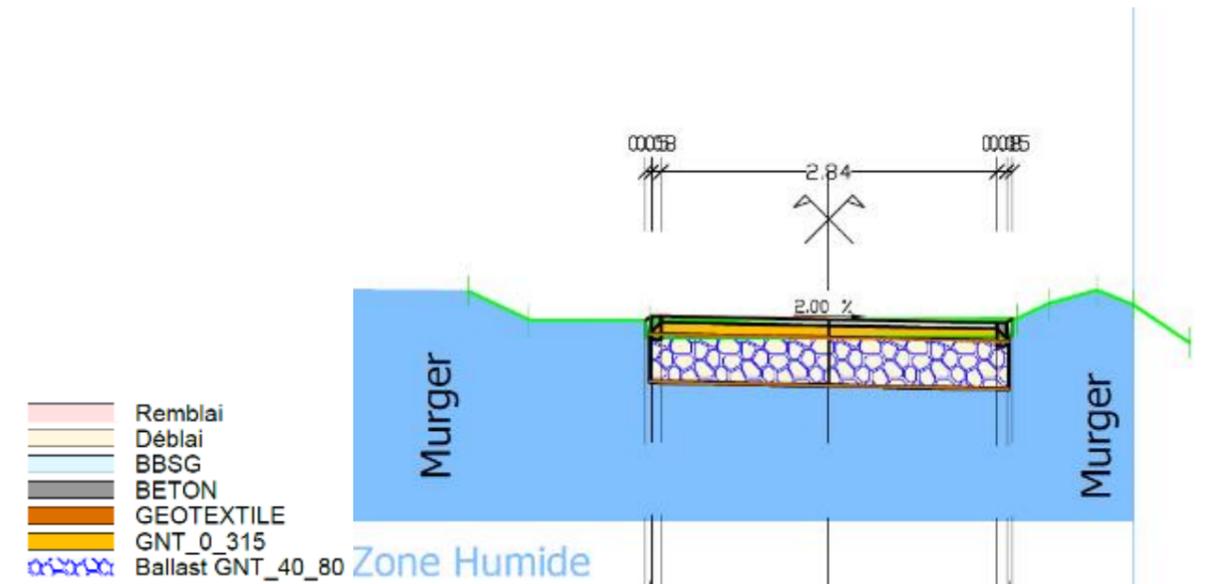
Profil sur la section 2-9 (Source : ABCD Experts)
